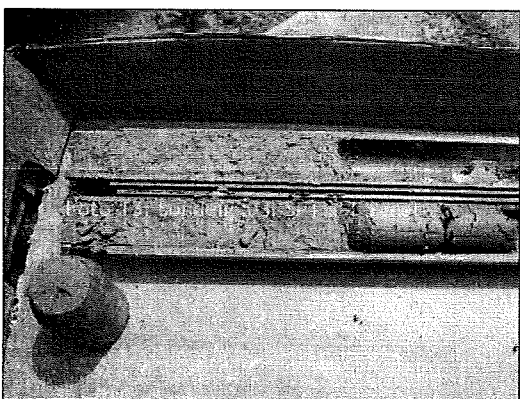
Sondeig S-4. SPT a 5,5 metres.
